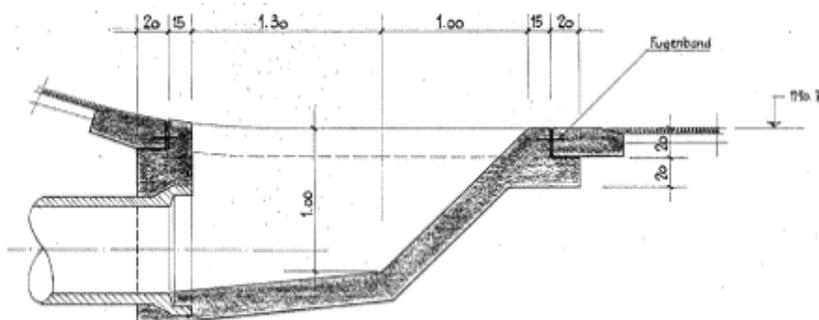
Schnitt durch den bestehenden Grundablass (Ausschnitt Plan Nr. 500-123).
